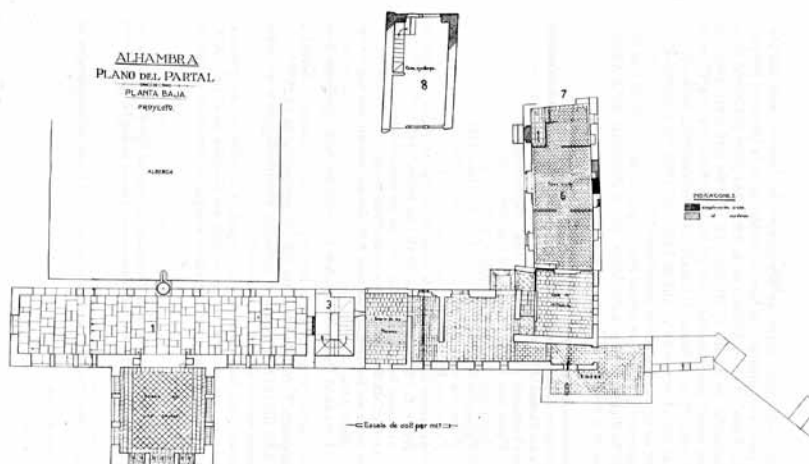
Leopoldo Torres Balbás (1923). Planta Baja del Plan de Conservación y Restauración del Partial. Proyecto. (Archivo de Planos de la Alhambra).
